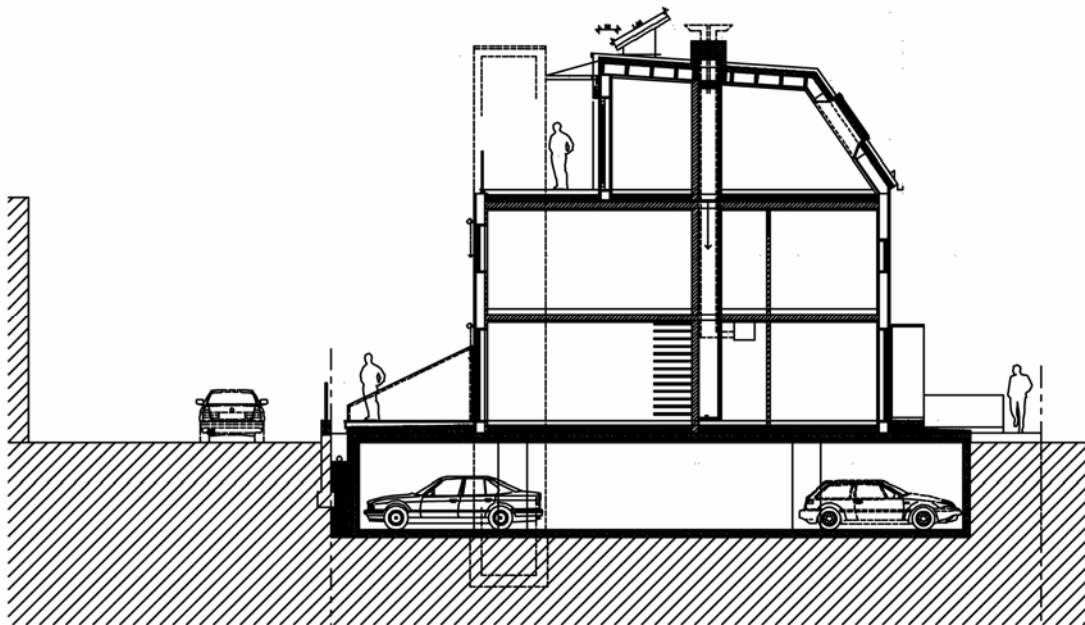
Schnitt Projekt „Smart Housing“ M 1:200
